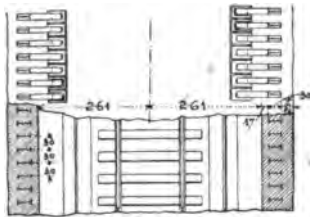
Querschnittsarmierung des Aspen-Tunnels.
